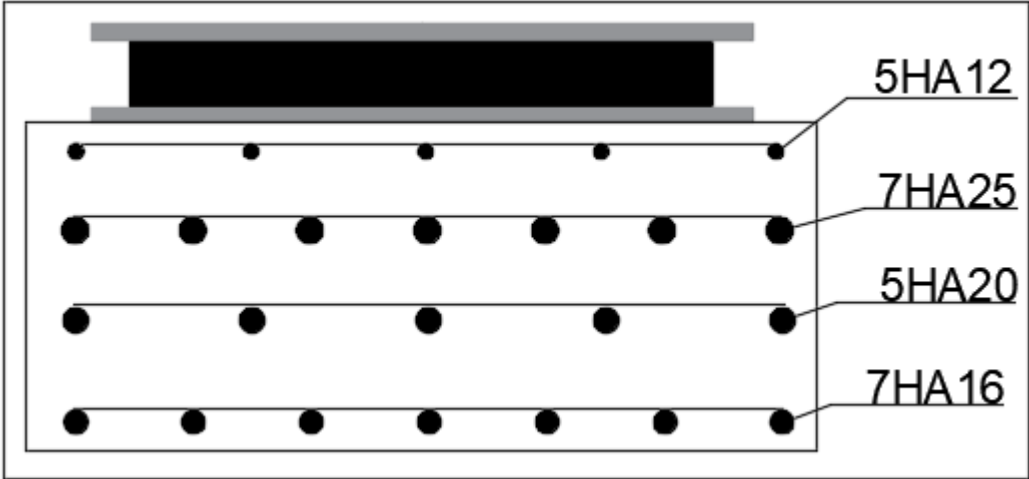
Ferrailage du dé d'appui au niveau de la culée.
